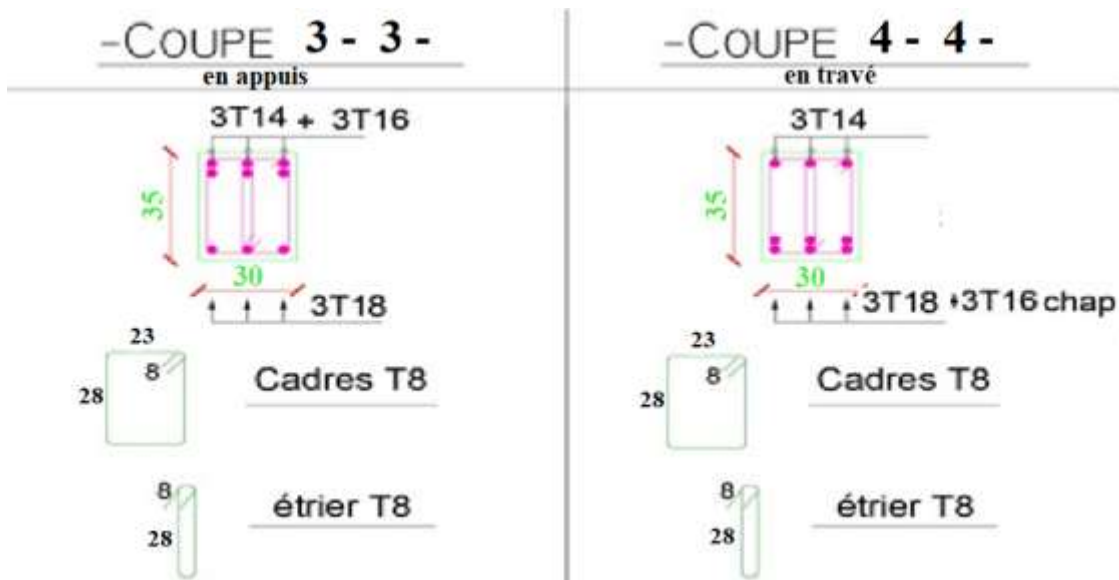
Schéma de ferrailage des poutres secondaires
